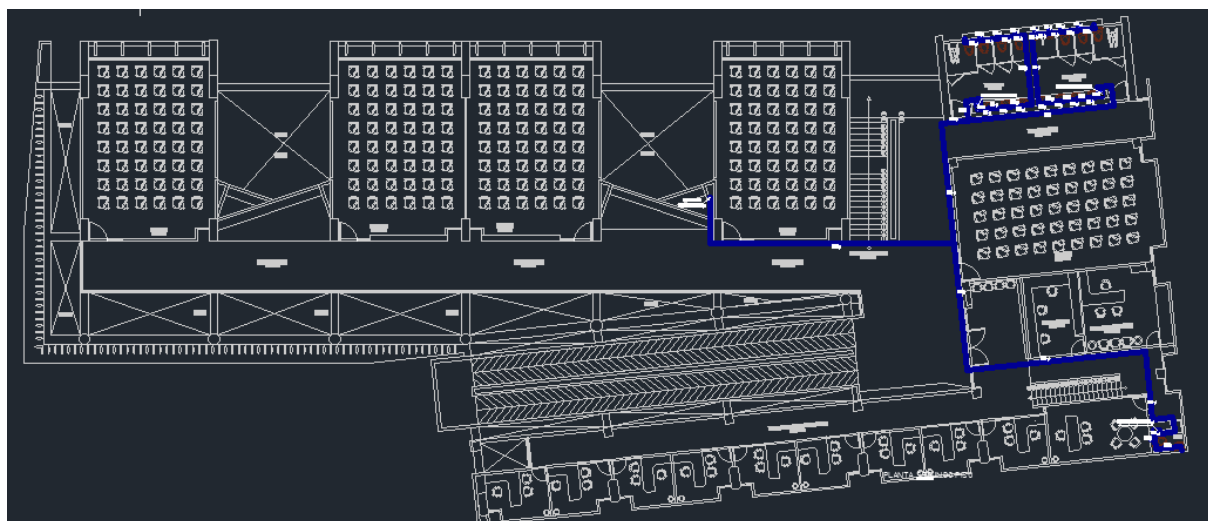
AutoCAD 2D Planta N°2 del edificio aulas oriente.
